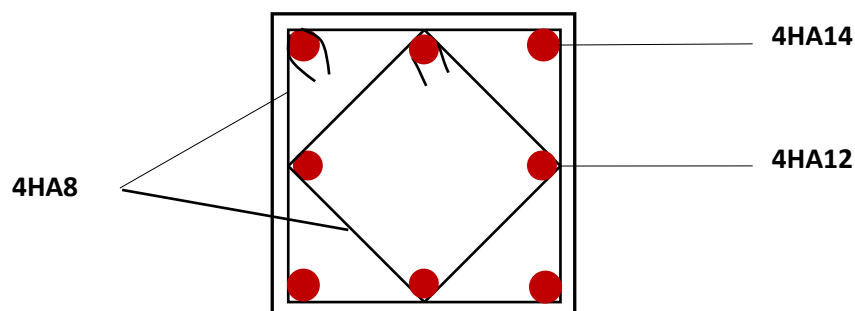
Schéma de ferrailage du poteau 35x35.
